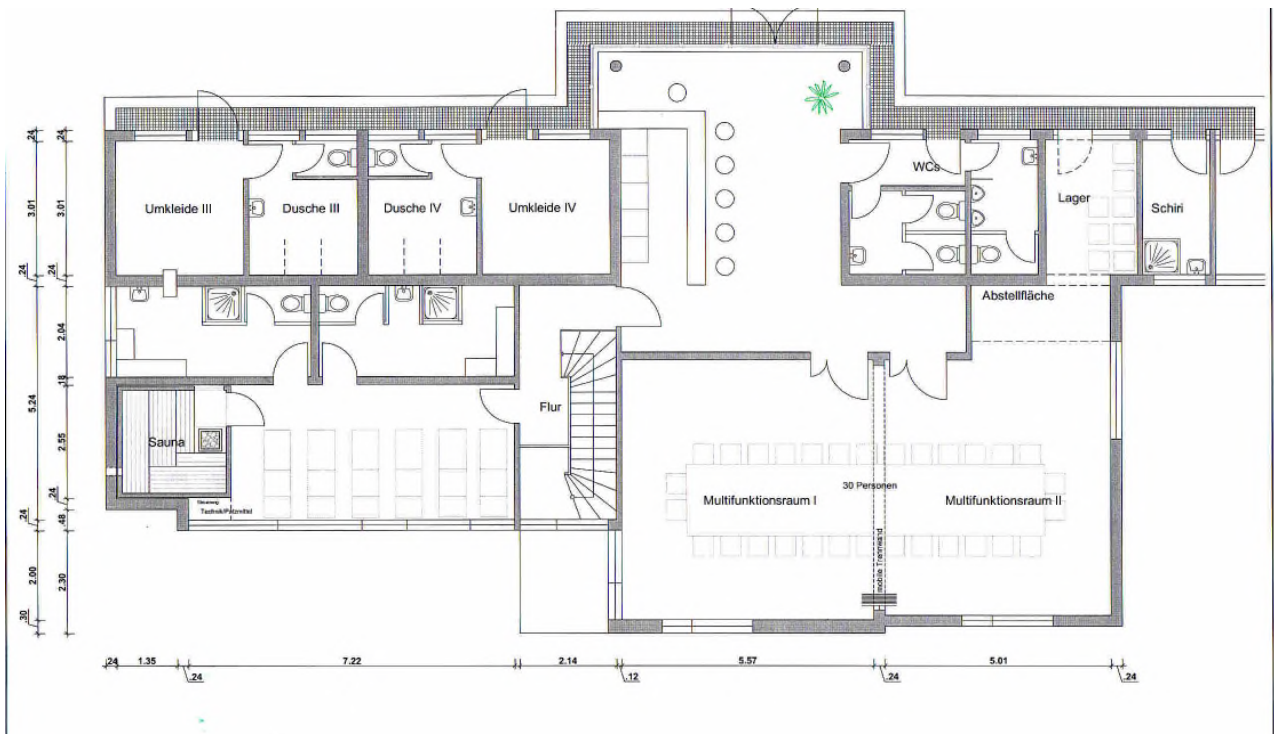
Grundriss geplantes Obergeschoss
